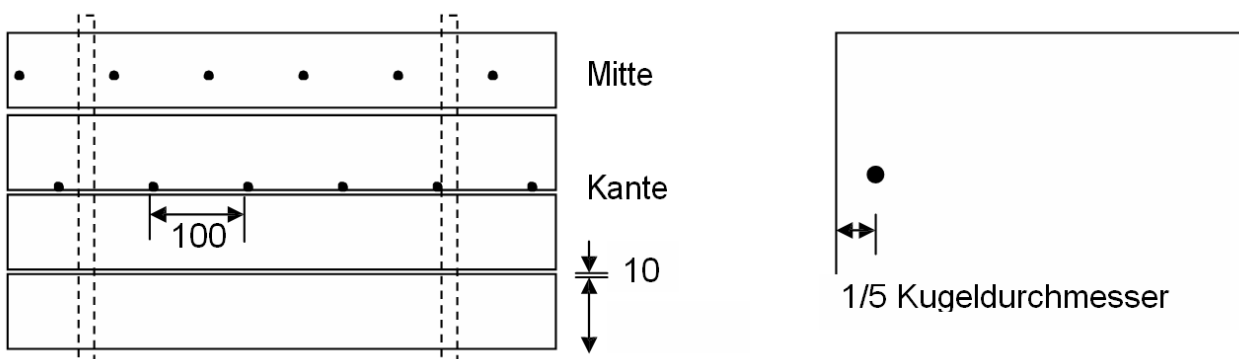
Beschussorte für den Beschuss der Holzteile im Grundriss (Masse in Millimeter)
